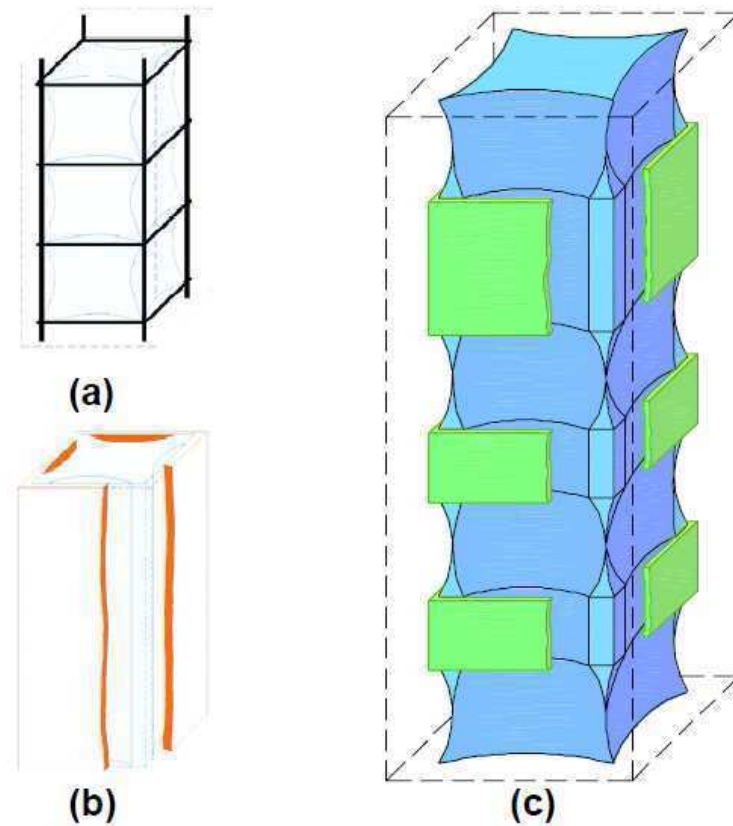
Confinamiento impuesto al hormigón de un soporte por: (a) Estribos; (b) Refuerzo de chapa continua; (c) Refuerzo de angulares y presillas (Adam 2007)
